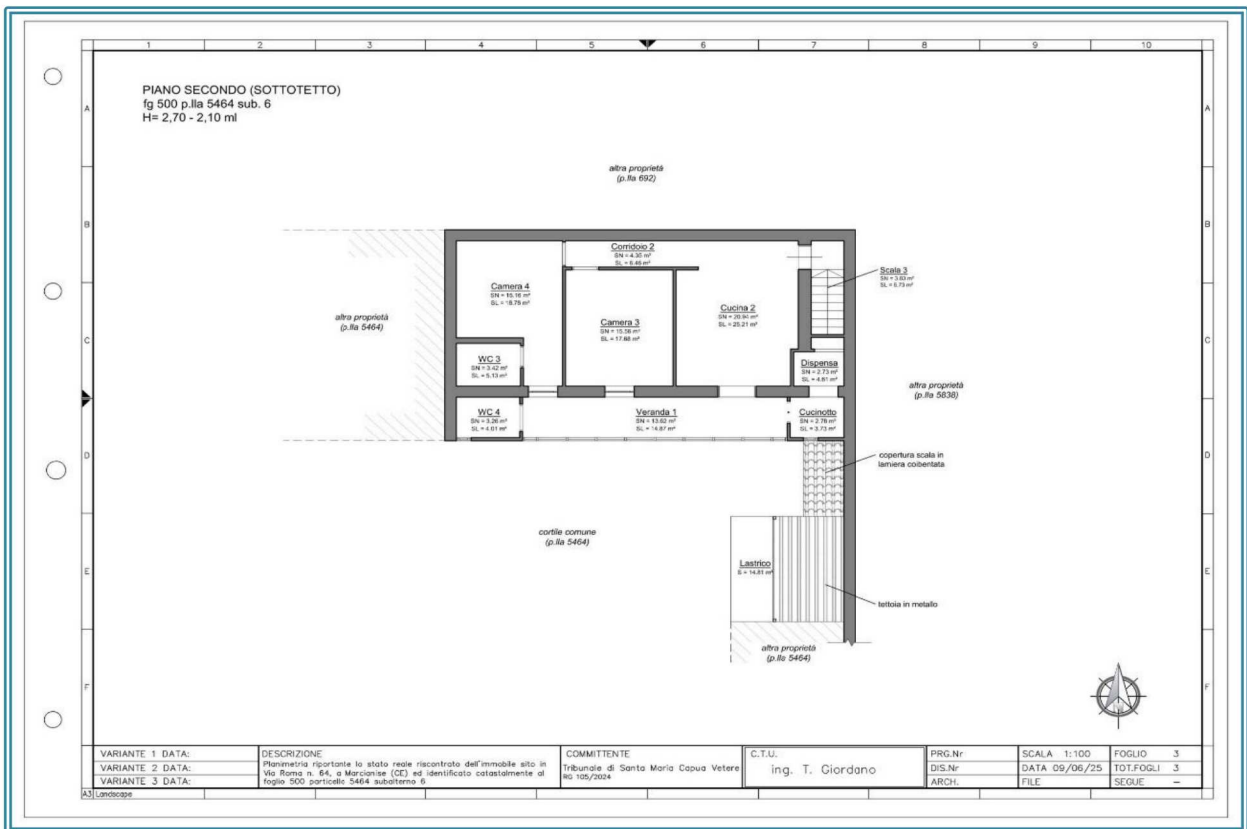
Stato attuale - Piano Secondo (Sottotetto)
